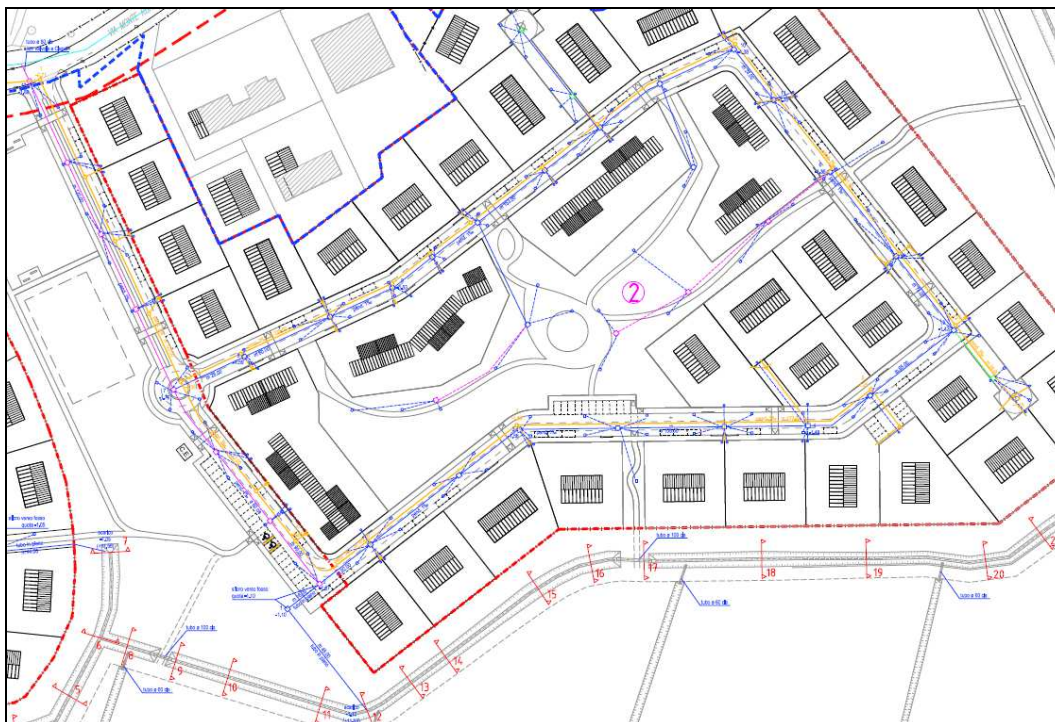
Planimetria della nuova rete di raccolta ed invaso delle acque di pioggia porzione più estesa del Piano di Lottizzazione Brentella.
